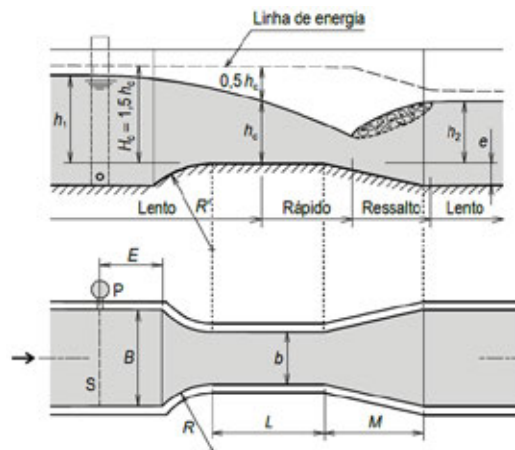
Planta e corte de uma caleira Venturi. Nota-se o poço de medição P
